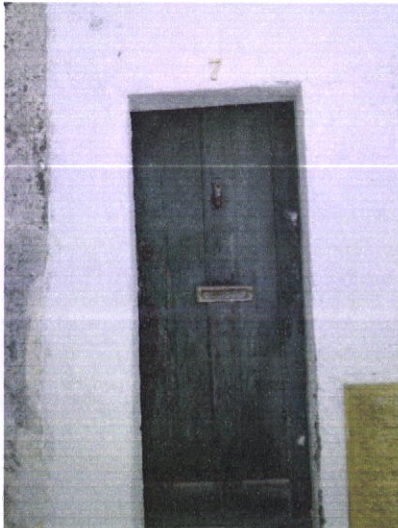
e 7.15 – Aplicação da madeira numa porta e aplicação da madeira a cumprir a função estrutural. Rua das Beatas. (foto do autor)
